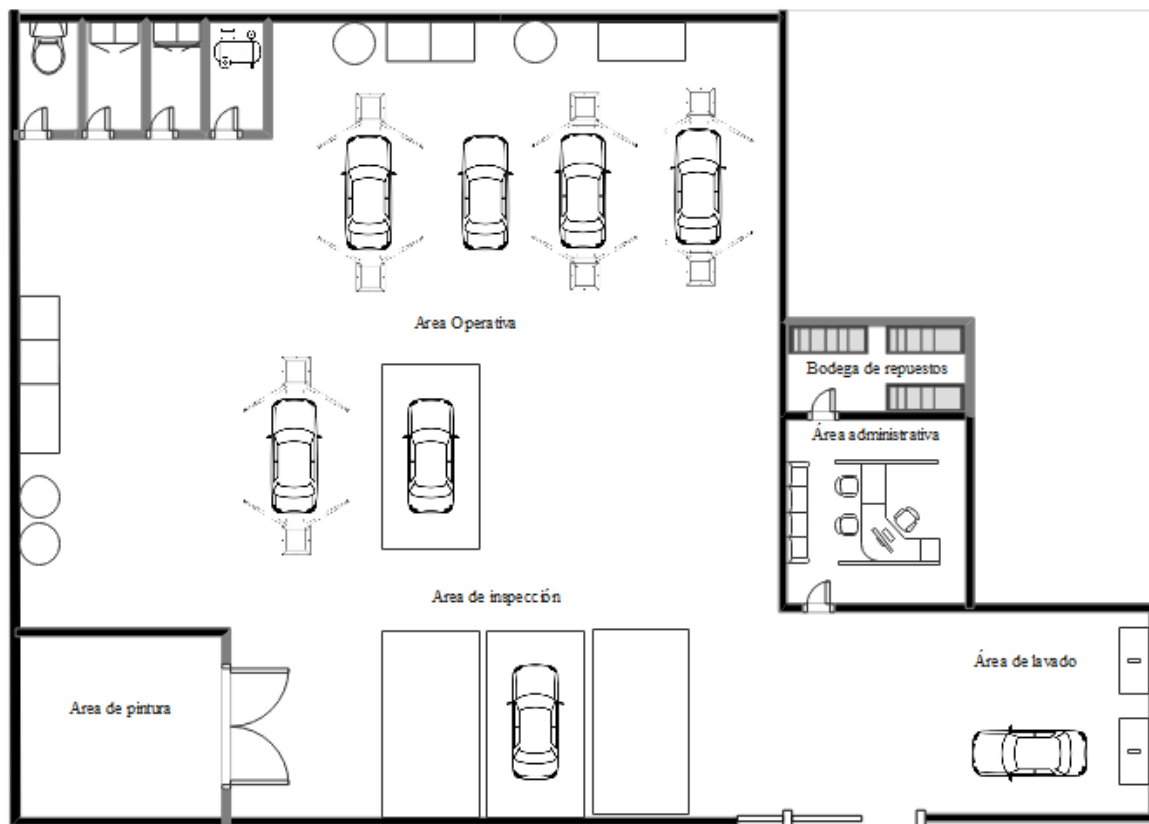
Distribución de planta de la empresa SIM AUTO.
